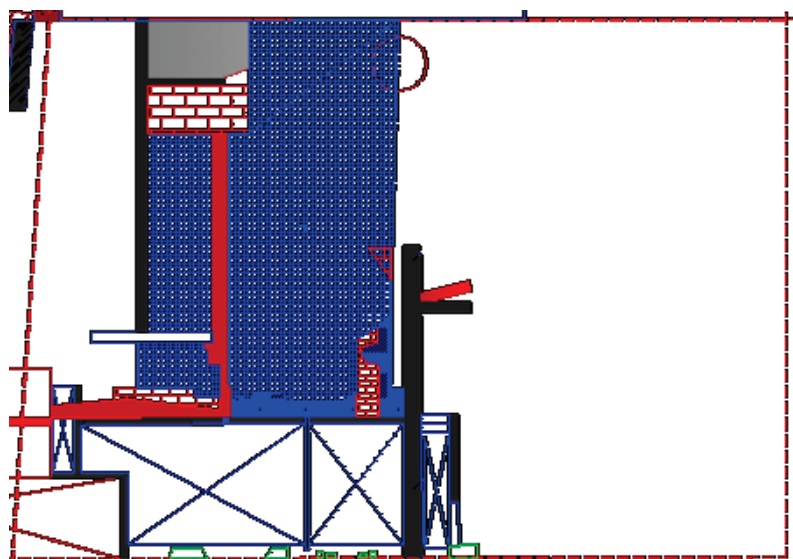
Planta final de la excavación presentando las UEs desarrolladas en área.
